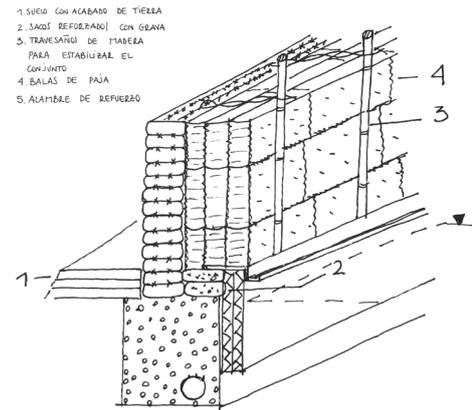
Detalle constructivo de tierra encadada más balas de paja. Elaboración propia basada en esquemas del libro Ceramic Houses & Earth Architecture
